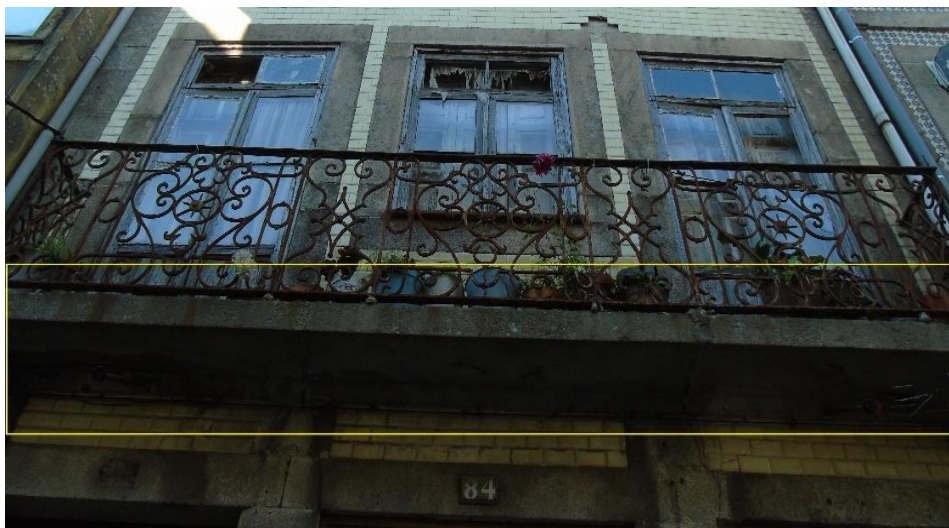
Pormenor de ligação da varanda com a estrutura da fachada principal.
